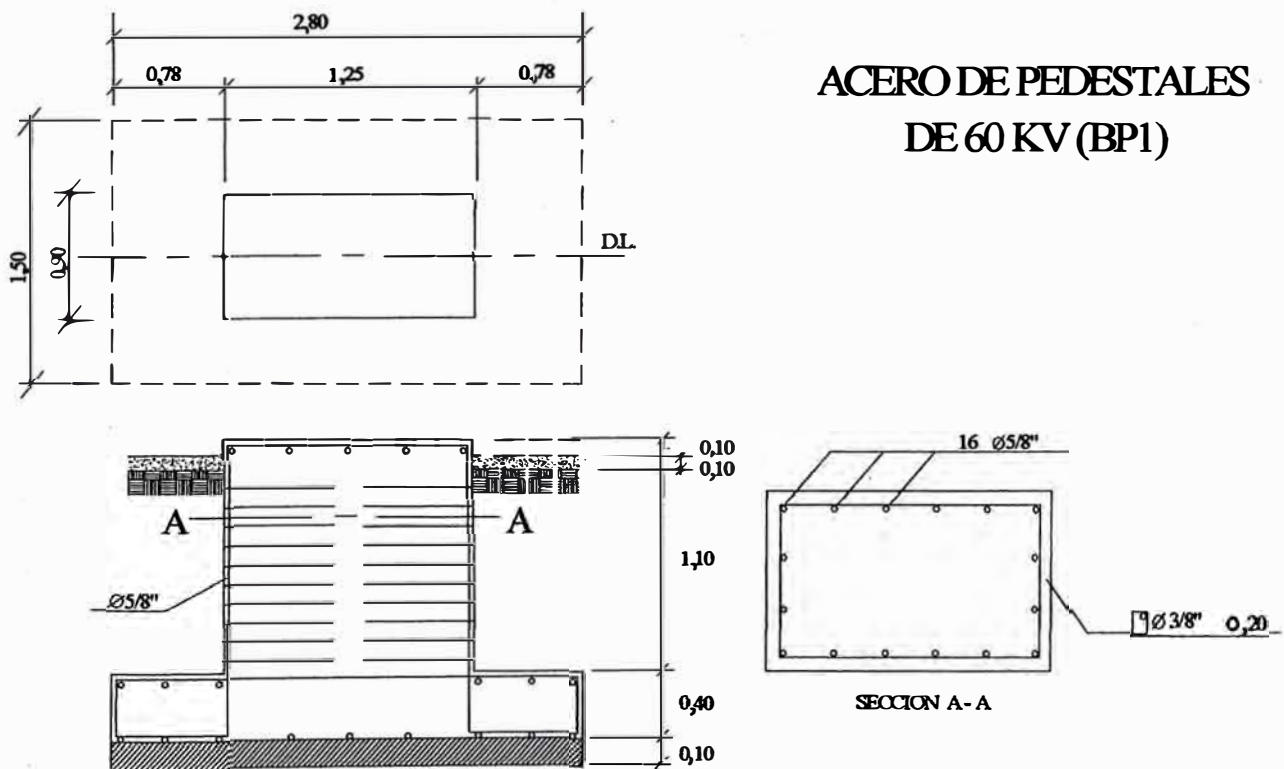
Vista de corte y de planta de la base de pórticos
